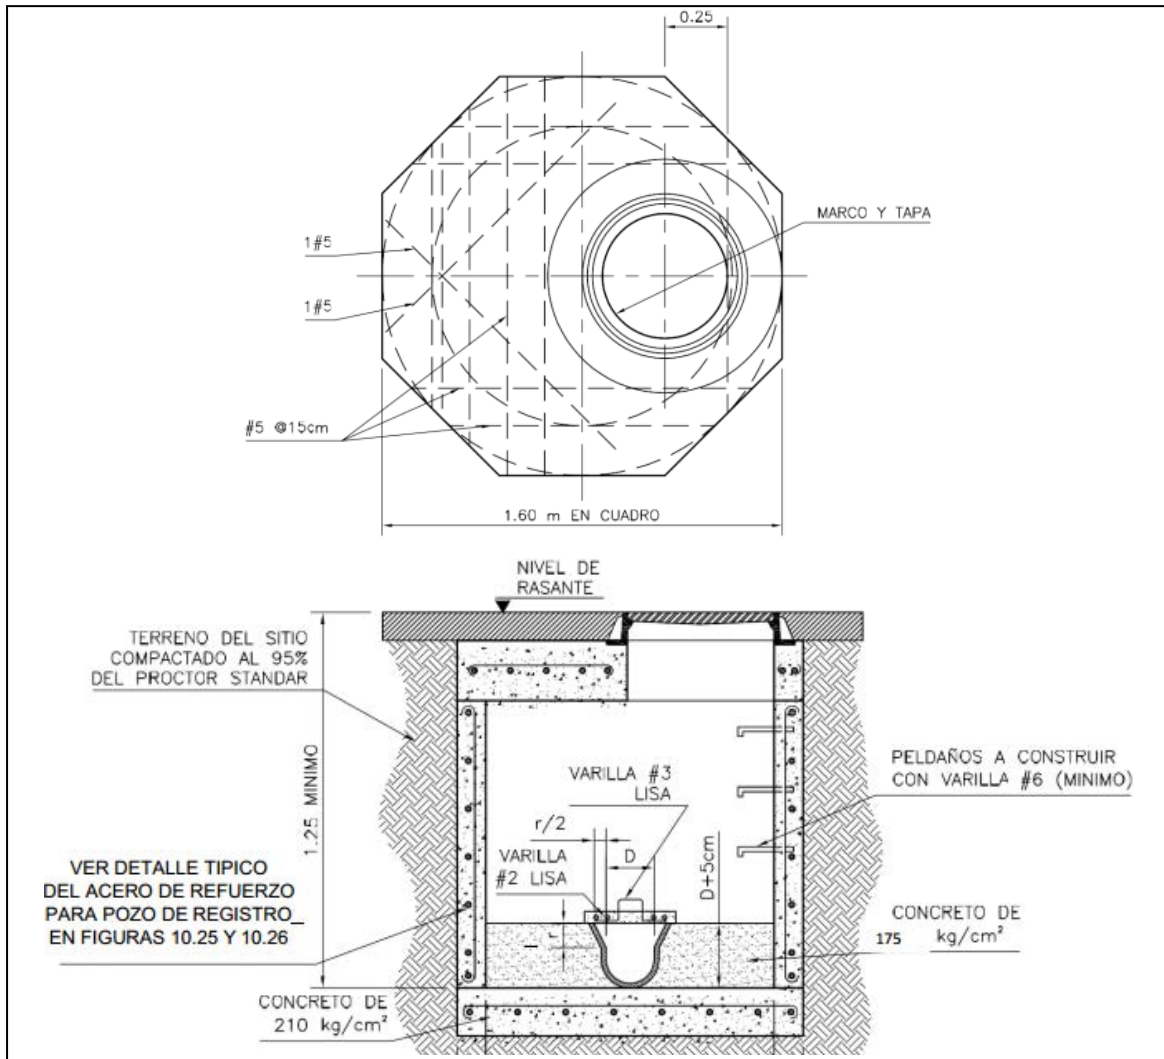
Detalle en elevación y planta de pozo de registro sanitario
